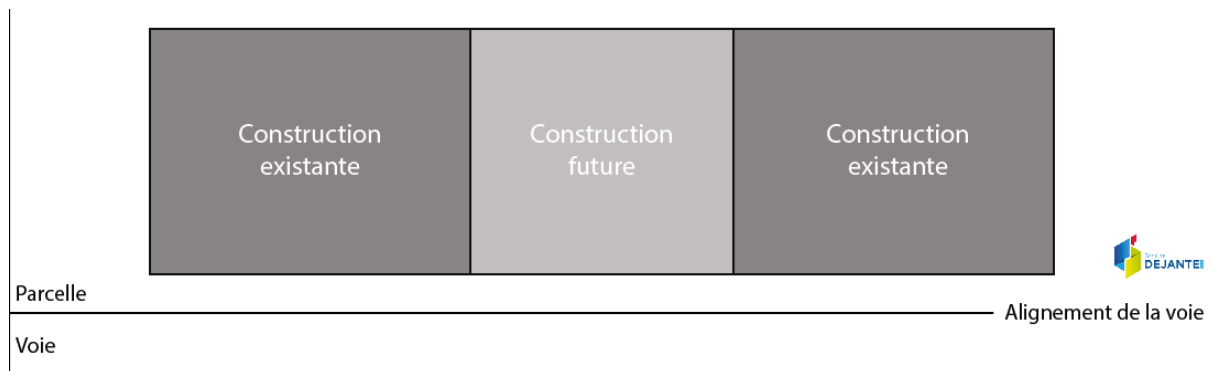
Implantation de la construction dans la continuité des constructions existantes si implantation en retrait de l'alignement
